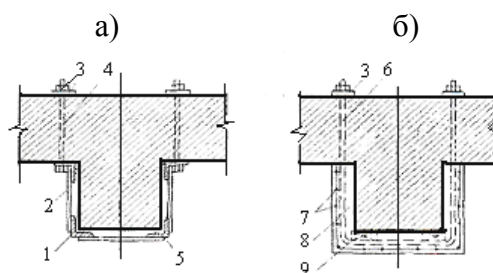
Усиление пилястр стальными (а) или железобетонными (б) обоймами:
